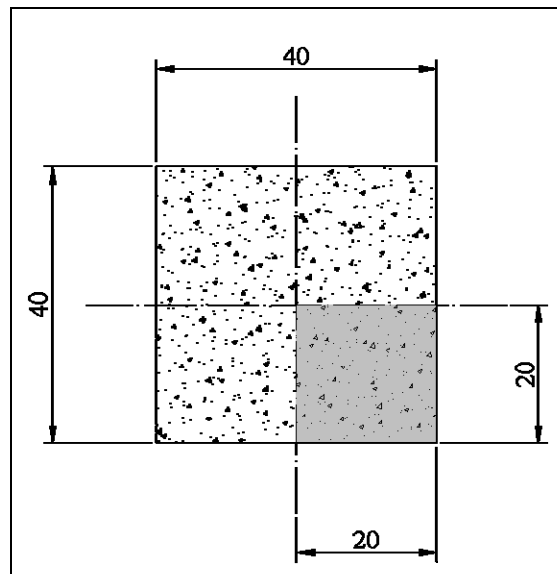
dimensões da seção transversal do pilar em estudo [cm].
